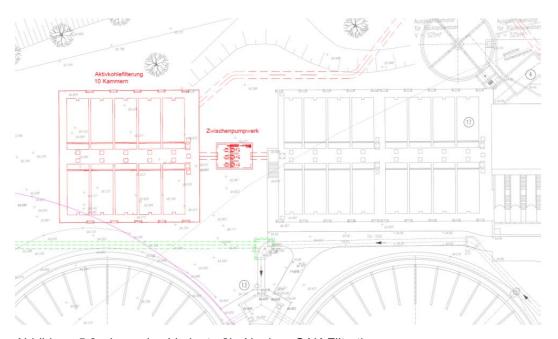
Lageplan Variante 2b: Neubau GAK-Filtration
